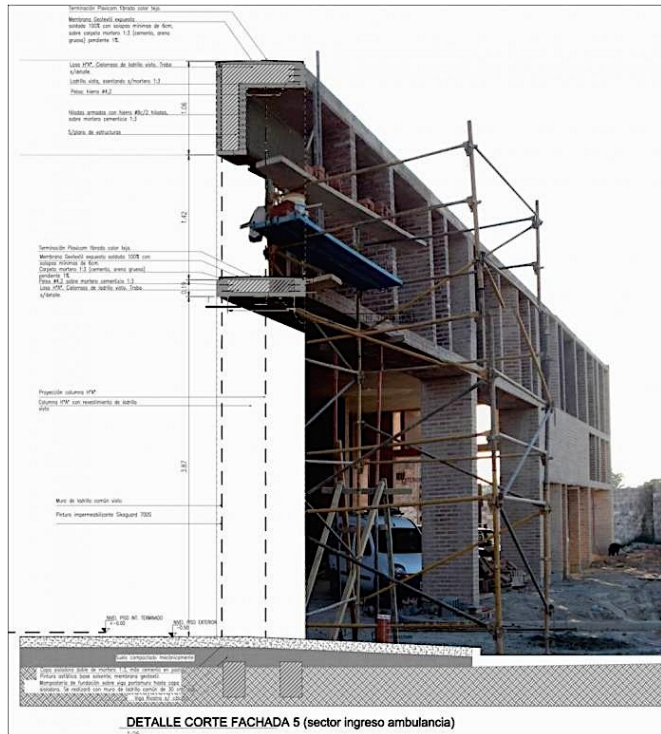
Corte por fachada del de acceso ambulancias. Achurado en diagonal representa el concreto armado y el color gris en su exterior el ladrillo tradicional. arqa.com
